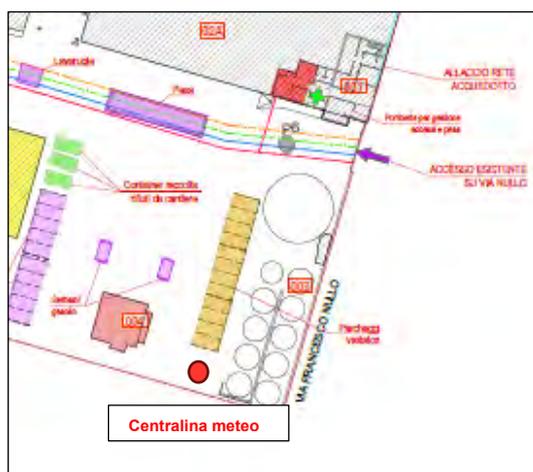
Posizione centralina meteo (su base planimetria cantierizzazione, soggetta a revisione in base avanzamento cantiere)
